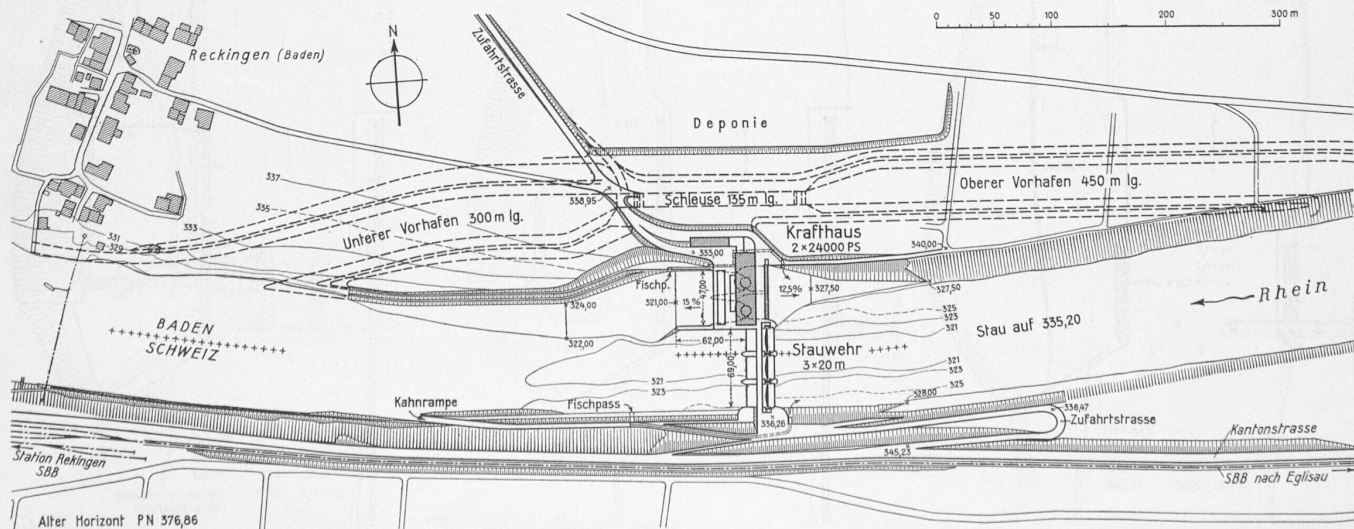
Lageplan 1:6000 des Rheinkraftwerkes Reckingen, mit der zu späterer Ausführung vorgesehenen Schifffahrt-Schleuse
